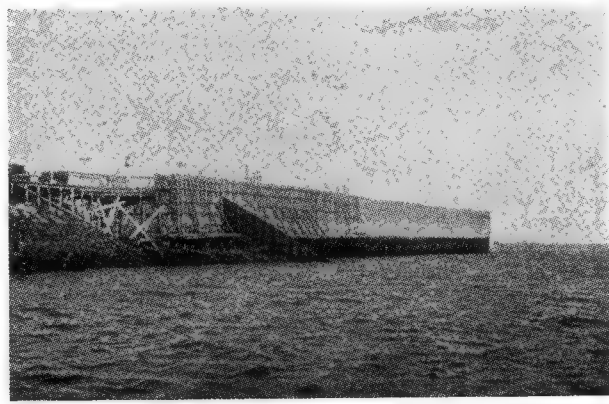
Enlace entre la parte del cemento armado y de piedra de la escollera.
